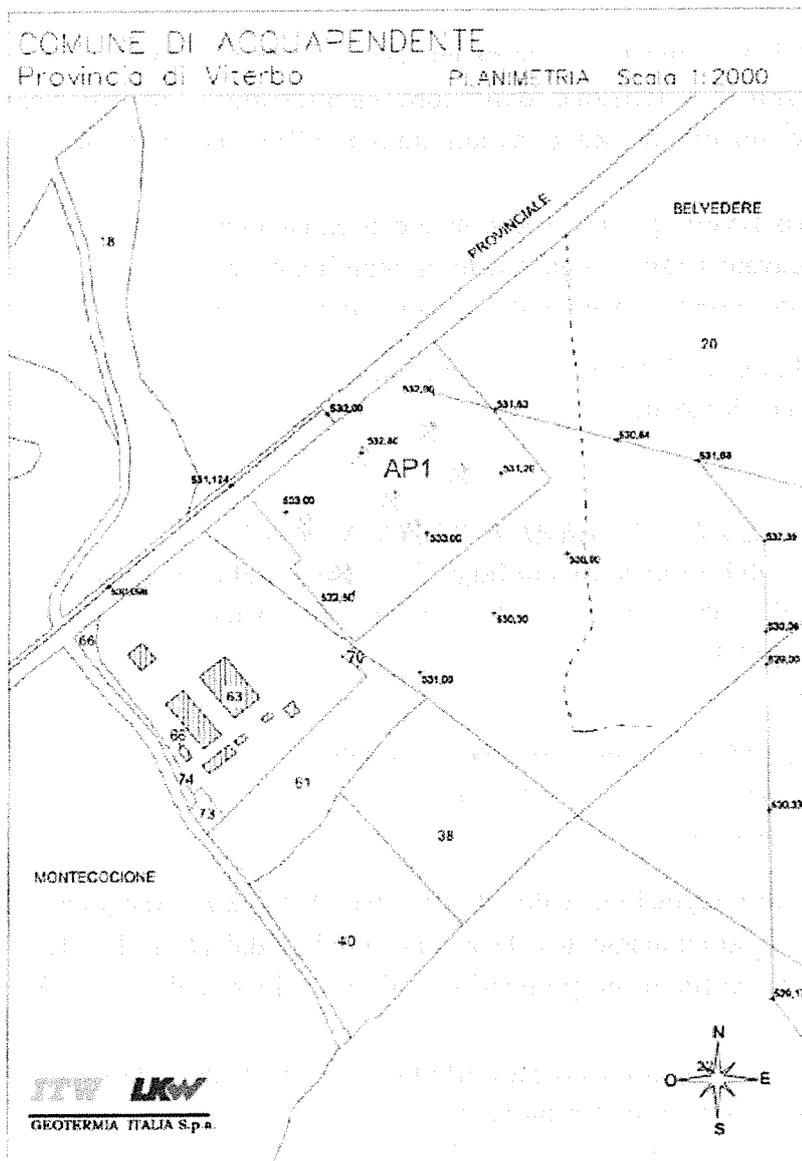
Planimetria della postazione AP1 con l'indicazione dei punti di sondaggio
